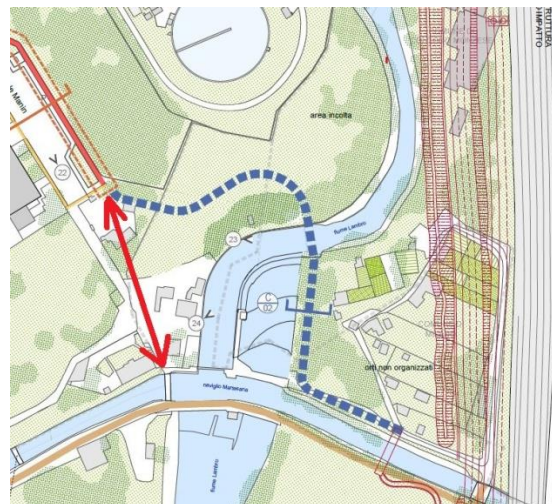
Progetto Attraversamento ciclopedonale Martesana: linea tratteggiata blu rappresenta l’ipotesi originaria con doppio attraversamento e pista sulla sponda del fiume; la freccia rossa l’ipotesi alternativa proposta
